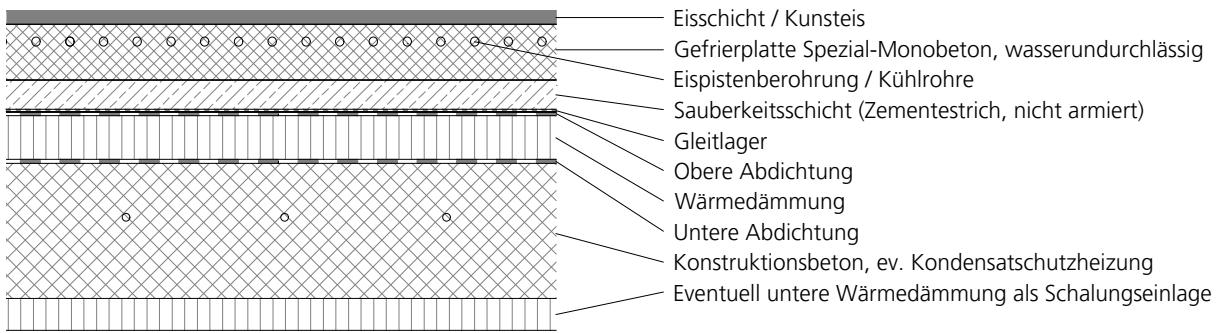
Beispiel Aufbau Kälteschicht auf Betonplatte mit Unterkellerung (wasserundurchlässig)
